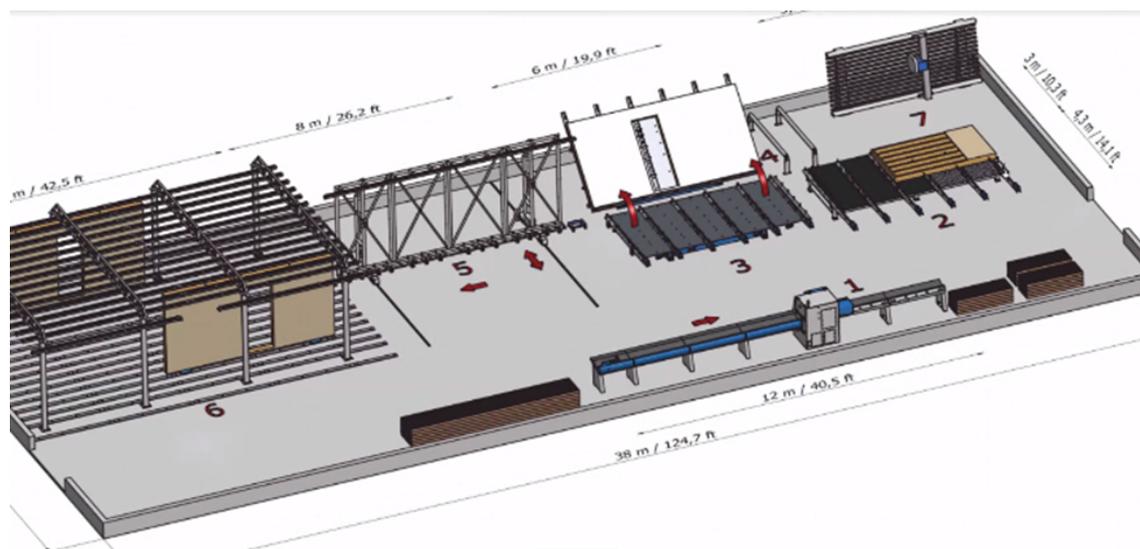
Esquema de un centro de panelizado para la construcción en seco.
